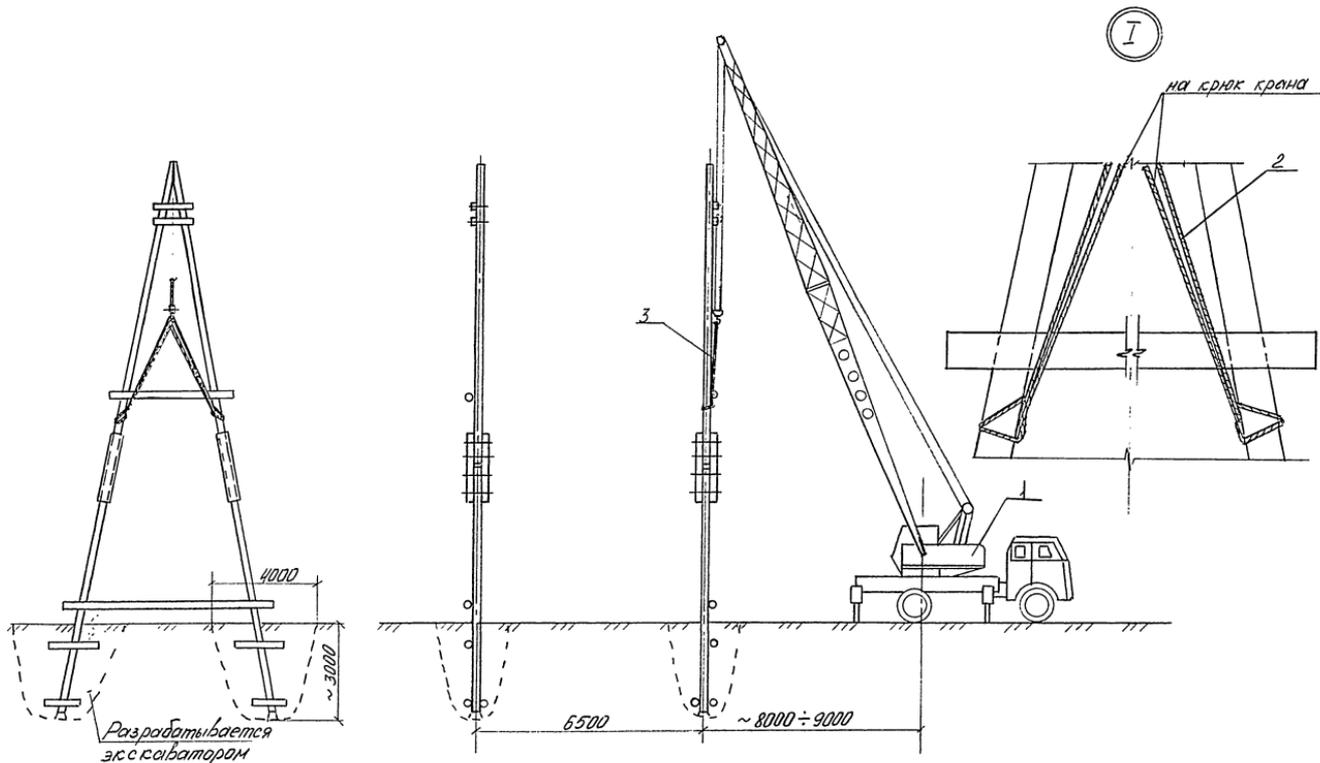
Вариант 1. Демонтаж опоры с пасынками.
